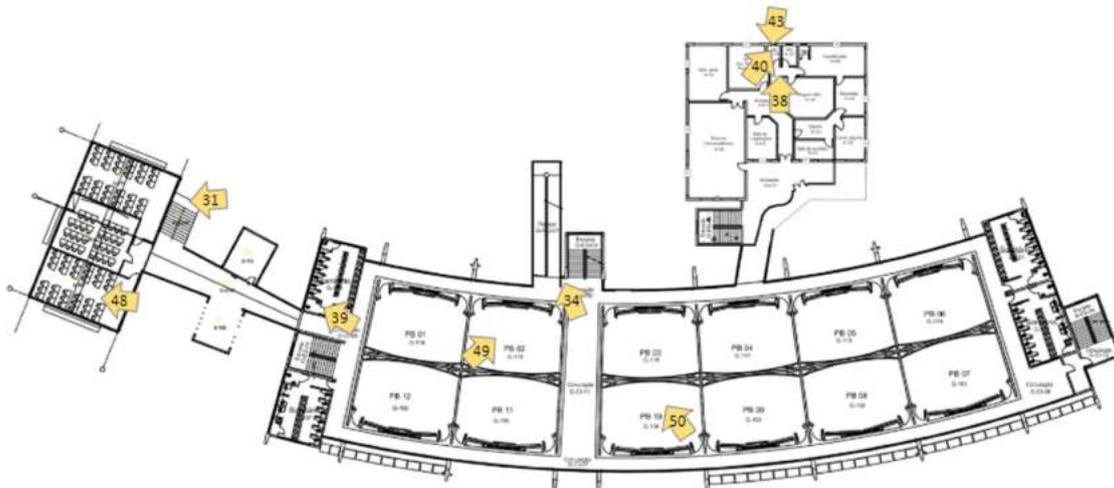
Planta do 1º pavimento do CB II – Montagem Autor: Silva, A. 2020
